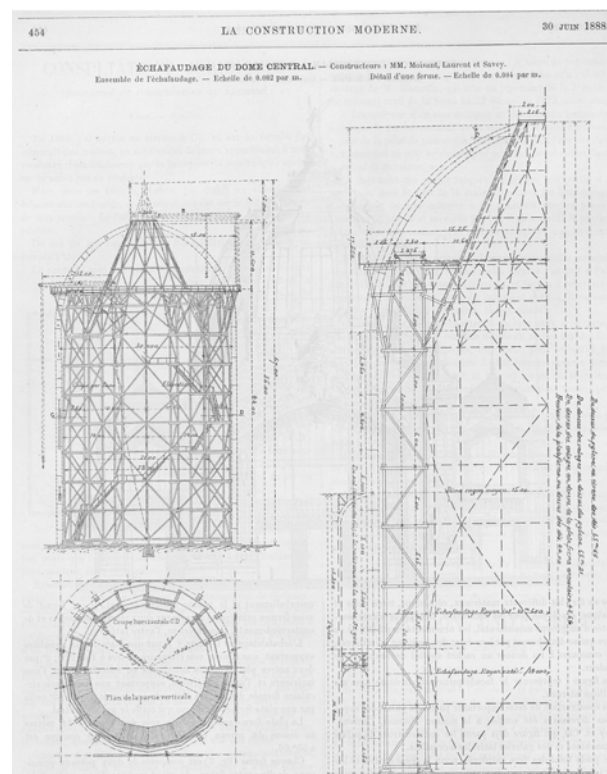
Échafaudage du dome central. Constructeurs: MM. Moisant, Laurent et Savey.. À esquerda o conjunto dos andaimes em planta e elevação e à direita, corte detalhando uma das pernas. (Fonte: La Construction Moderne, 1888)
